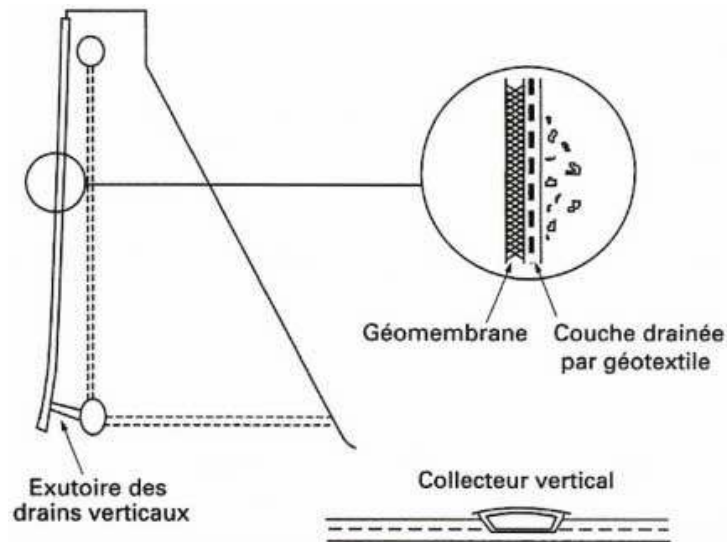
Imperméabilisation de la face amont d'un barrage en béton
